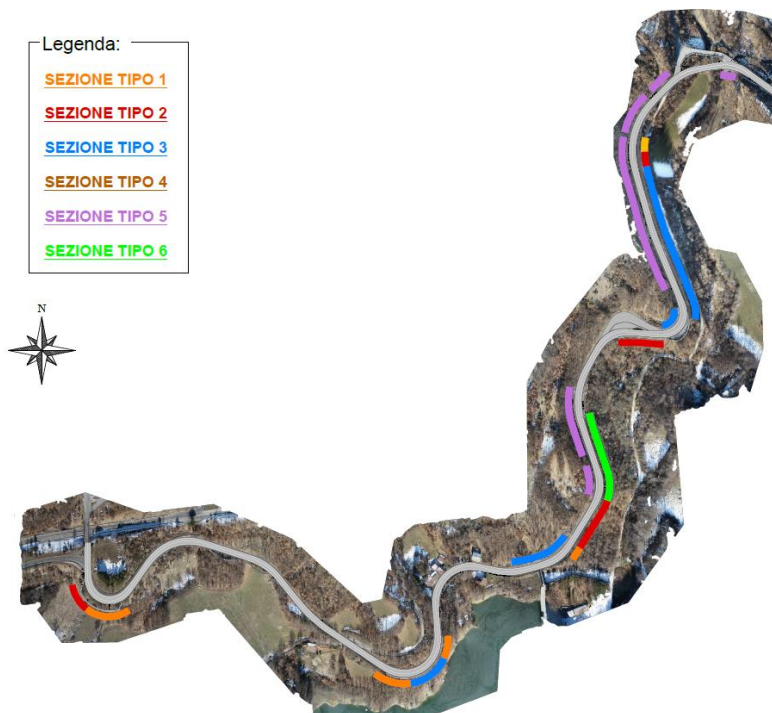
Localizzazione dei diversi interventi lungo il tracciato. Fonte " Progetto Stradale – sezioni tipo e particolari costruttivi", allegato alla Lista di controllo.
